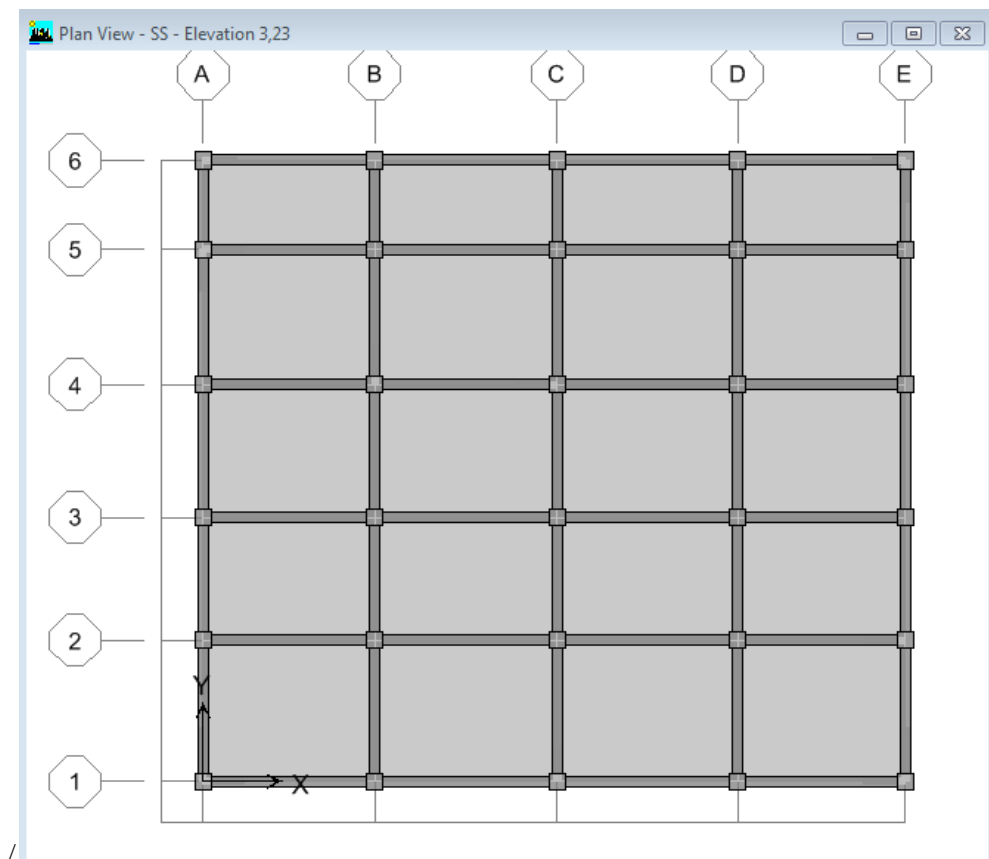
Vue en plan des éléments structuraux d'un étage
